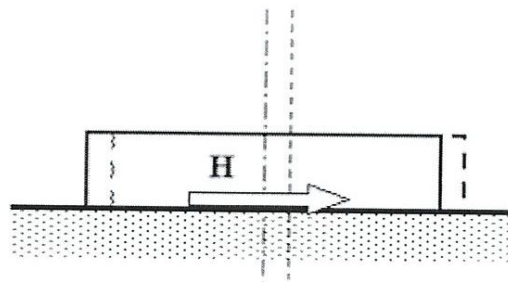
Rupture par glissement horizontal de la fondation (insuffisance de frottement à l'interface fondation - terrain).
